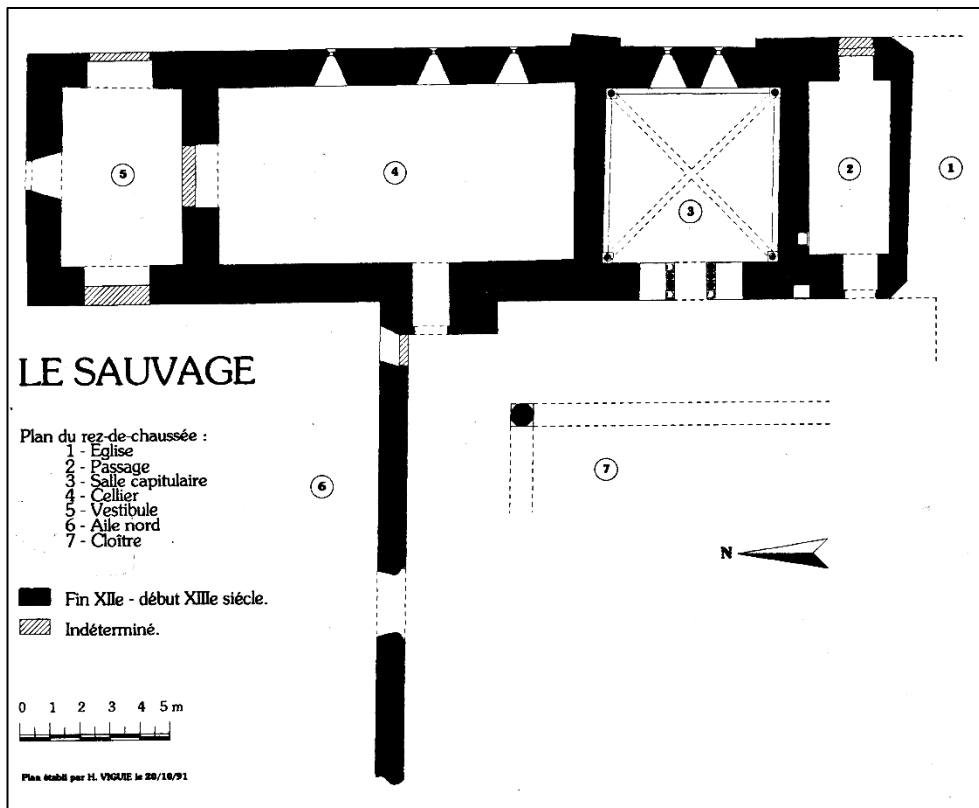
Plan du prieuré du Sauvage (Aveyron) (Durand, 1992 : 169).
